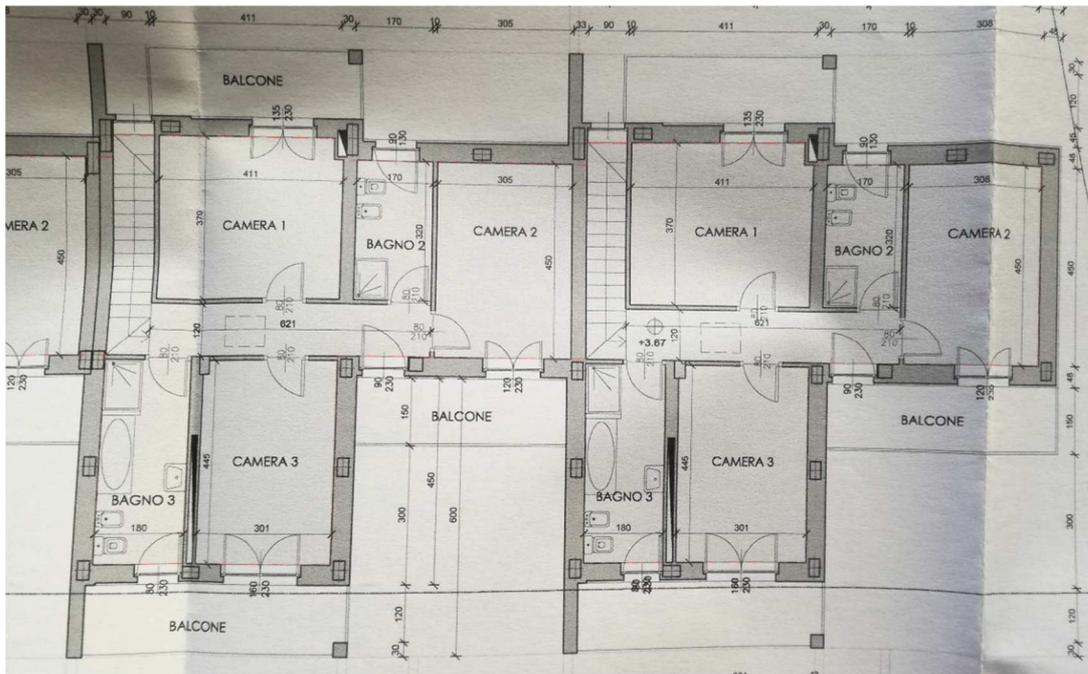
Pianta piano primo edificio bifamiliare in via F. Baracca 18
